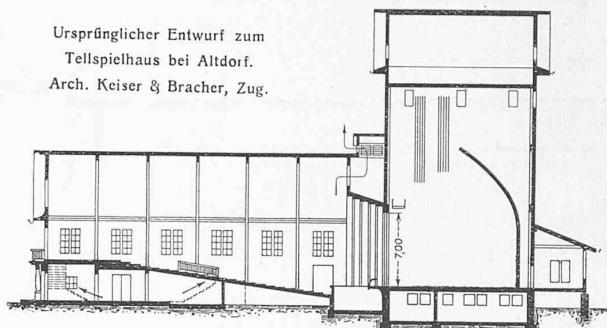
bis 8. Schaubild und Grundriss und Schnitt 1 : 600.
